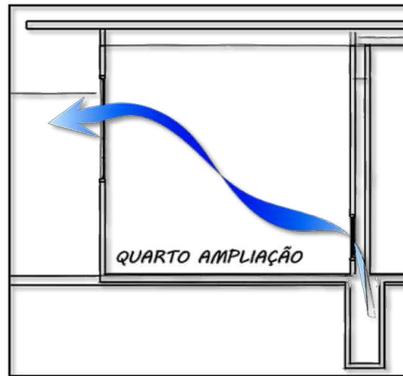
Corte Galeria de ventilação – Esquema saída de ar.
